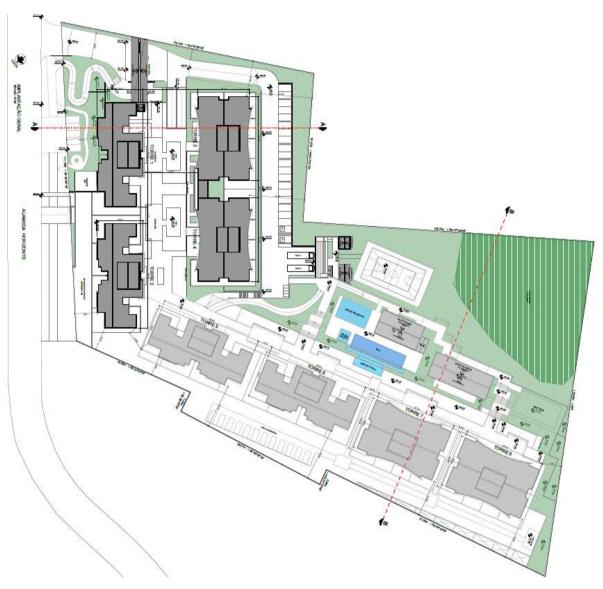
Projeto – Implantação. (Para melhor visualização ver anexo correspondente).
